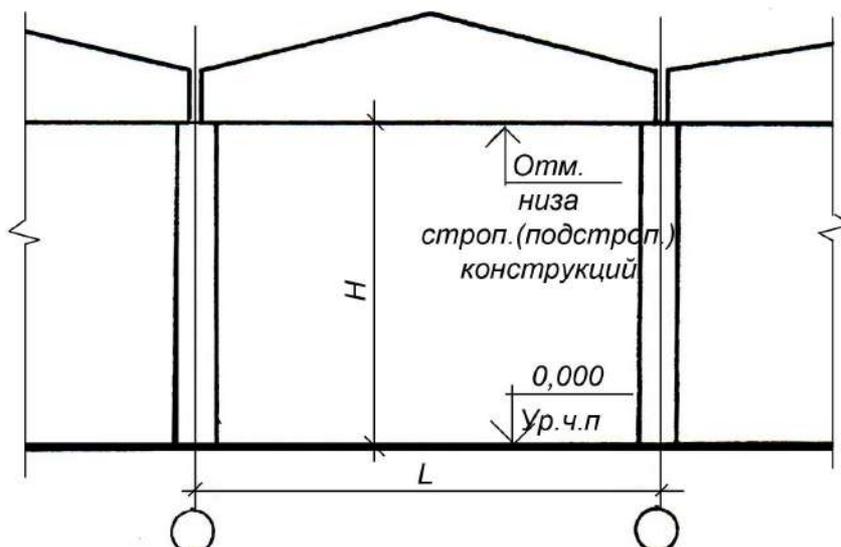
Поперечный разрез многопролётного ПЗ без мостового крана (схема)
